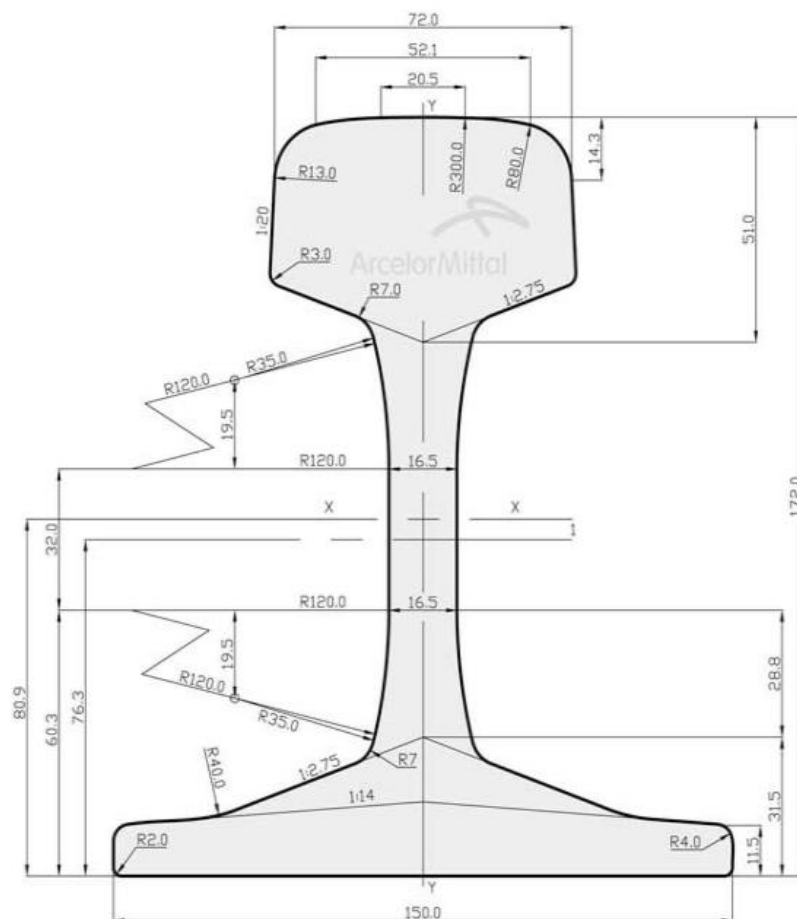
Carril UCI 60. Fuente: Acelor Mittal
